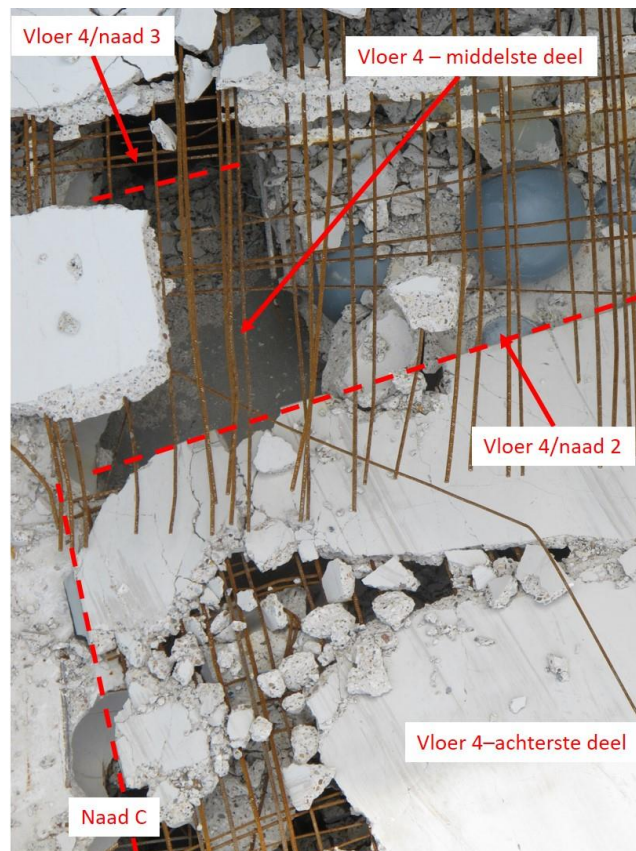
Detail van het ingestorte deel ter plaatse van naad C
